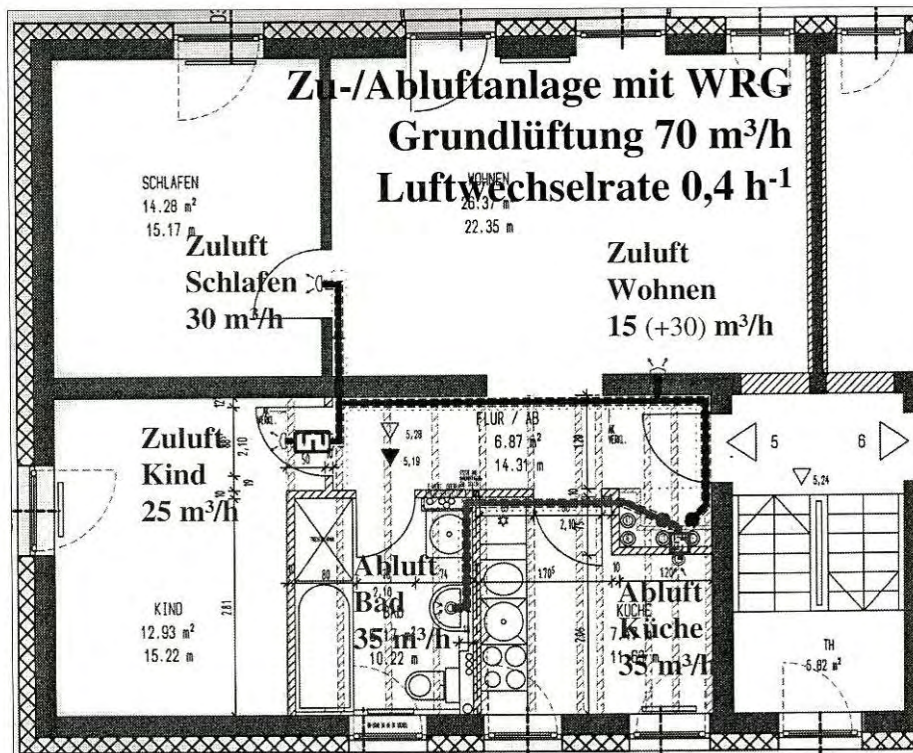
Anlagenkonzept mit Leitungsführung und Luftwechsel im Grundriss
